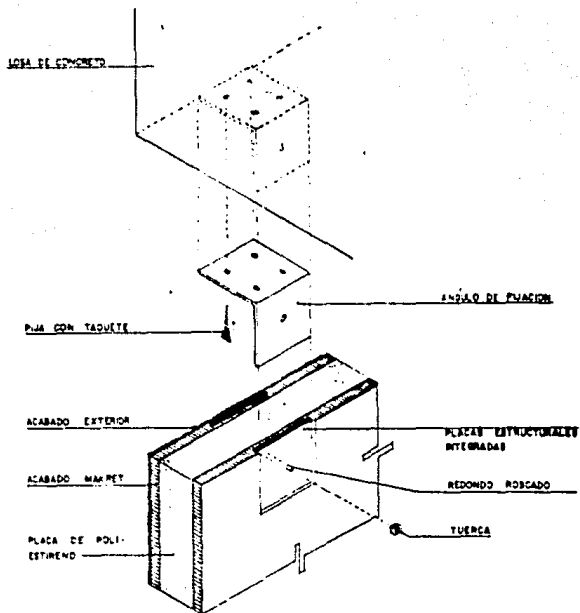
Proceso de colocación de exterfoam en losa de concreto.
